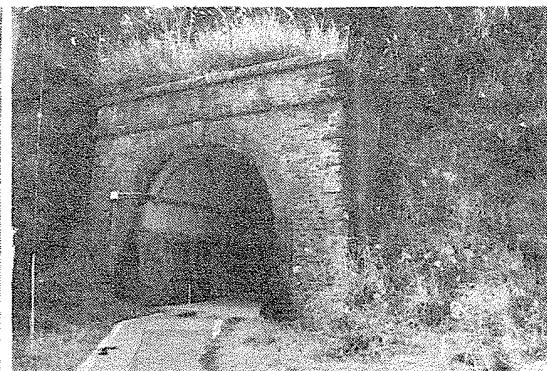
米山第五号トンネル(No.57) 出口方の坑門 '92.11.22
